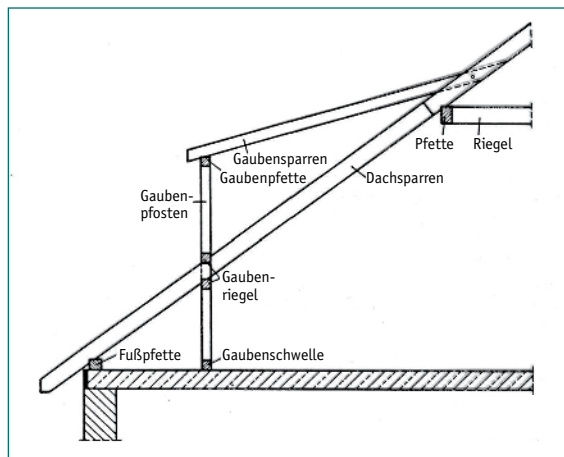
Dampf- und Luftsperrung bedürfen hier einer aufwendigen Planung und Ausführung.
